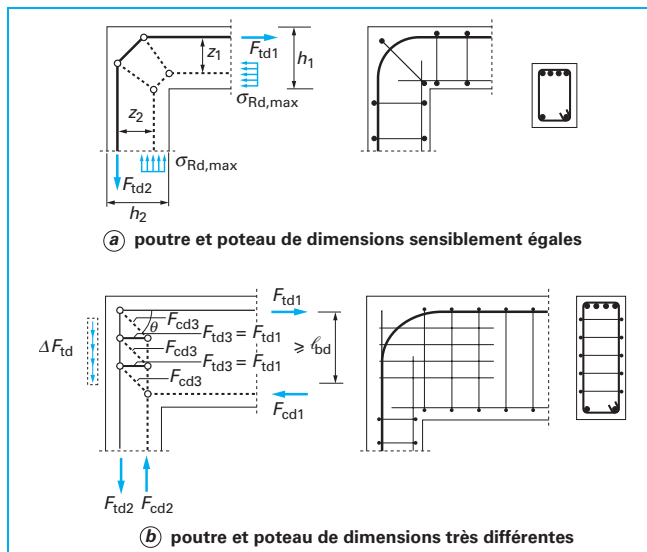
Modélisation et ferrailage d'un angle de portique dont l'intérieur est comprimé (figure J2 de l'EC2)
